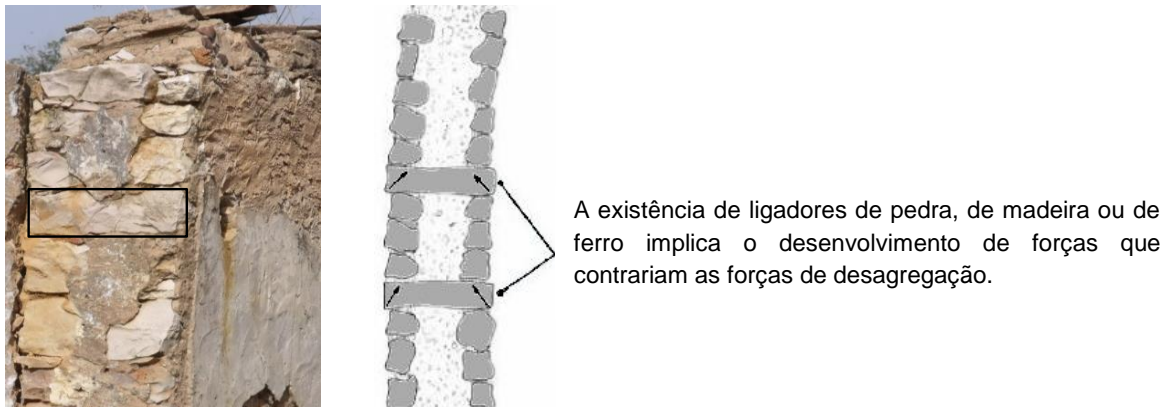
Secção transversar, perpianhos ou travadouros.
